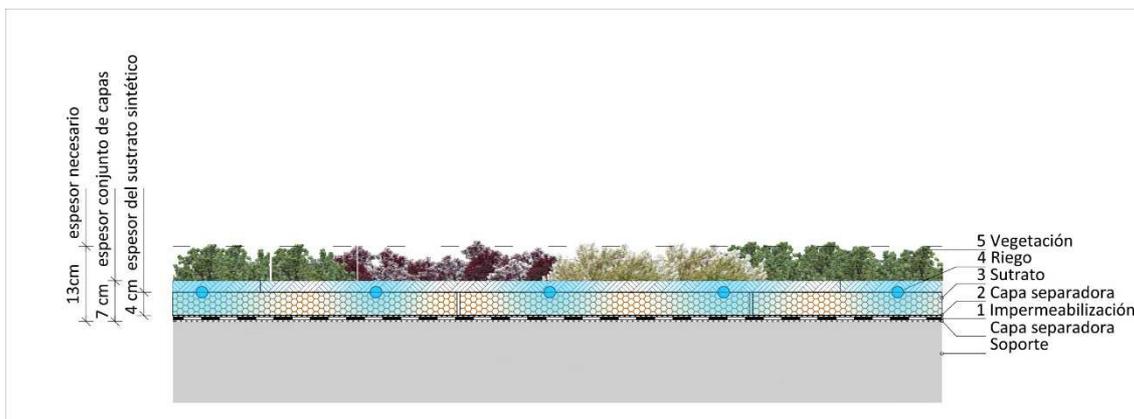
Detalle constructivo Cubierta vegetal Rizoma [2]
